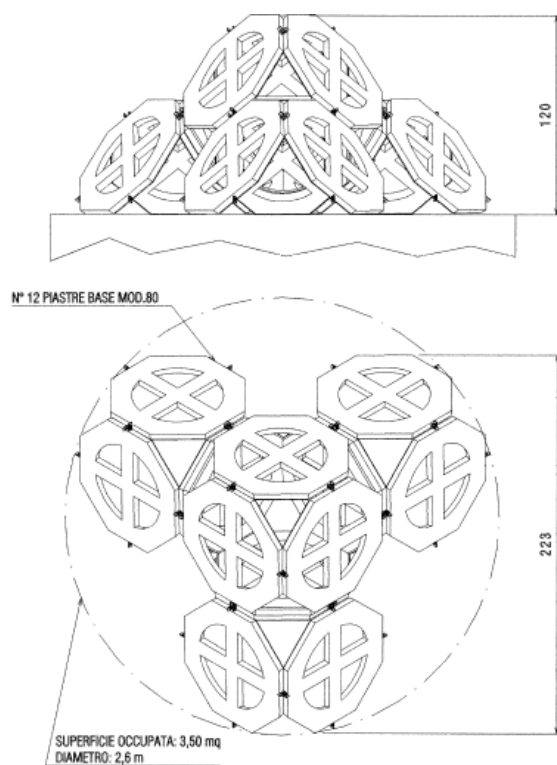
Barriera “Tipo 3”; Struttura Tecnoreef da n° 10 celle base, 12 piastre Tecnoreef Mod. 80 aperte.
